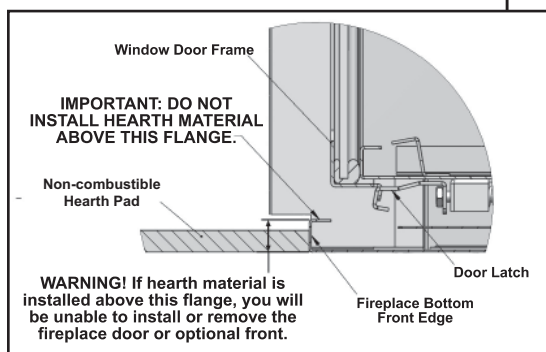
Section du foyer pour un plancher surélevé - AVERTISSEMENT.
